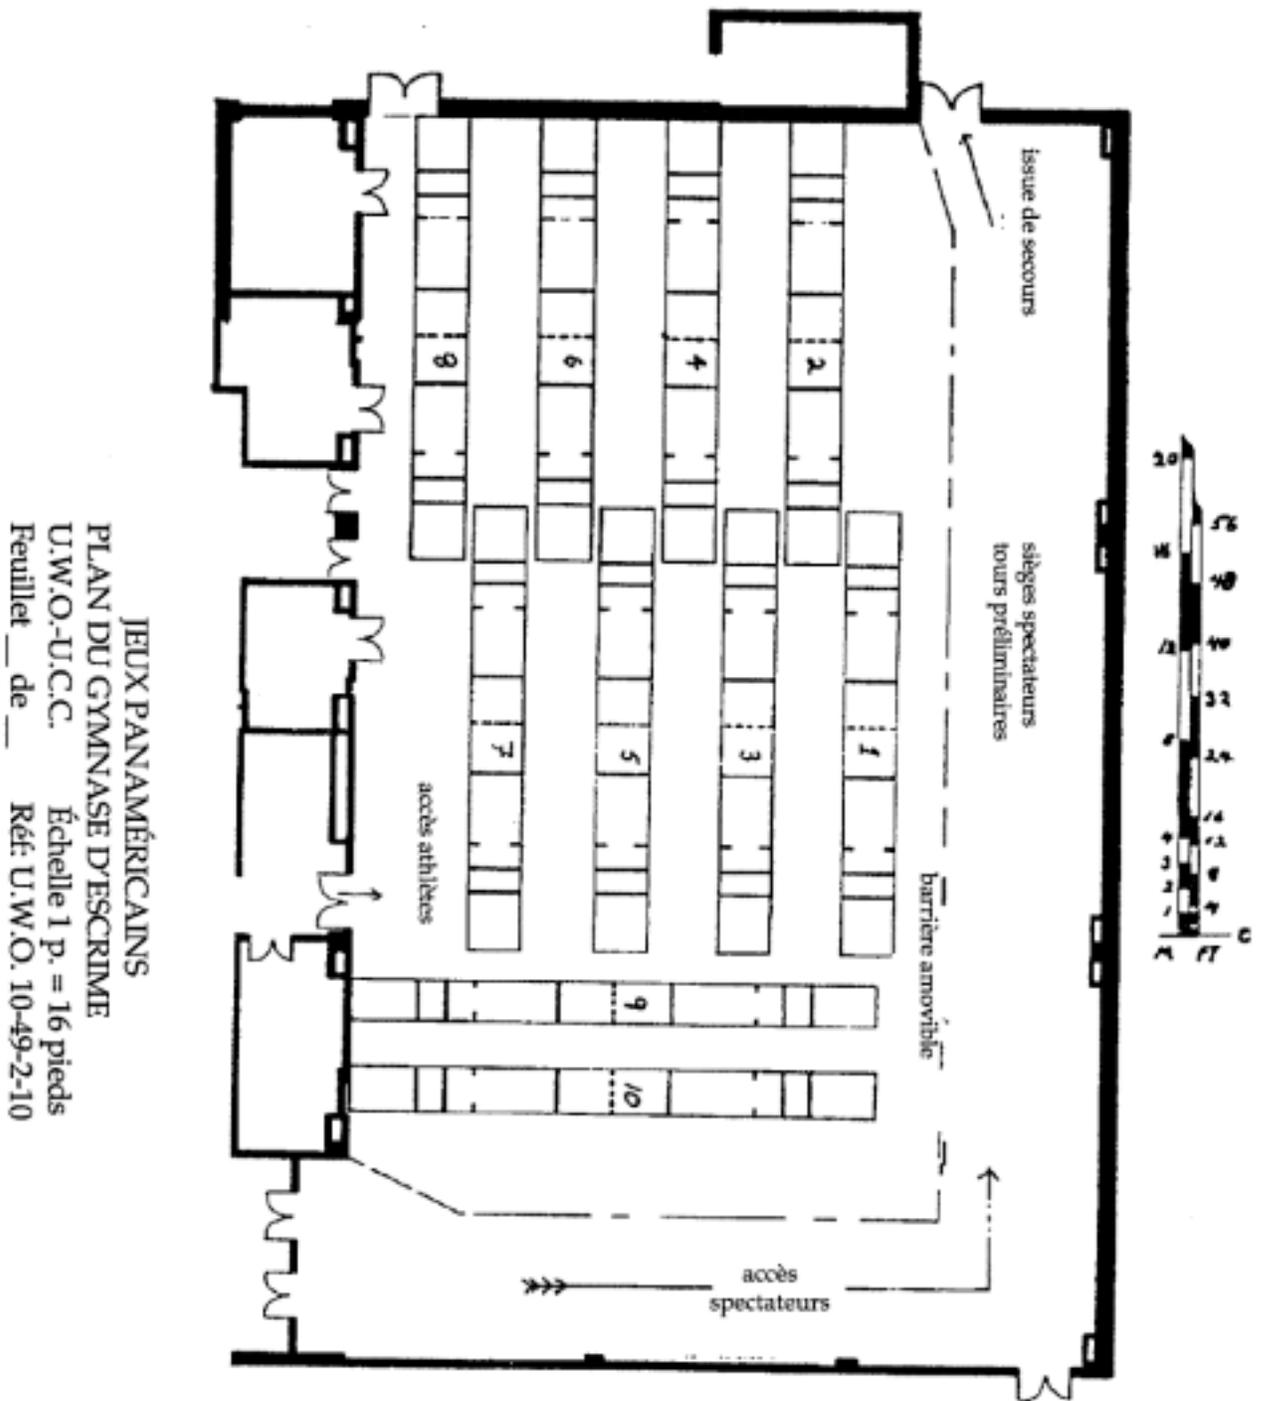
PLAN COMPLET D'INSTALLATION DES PISTES
